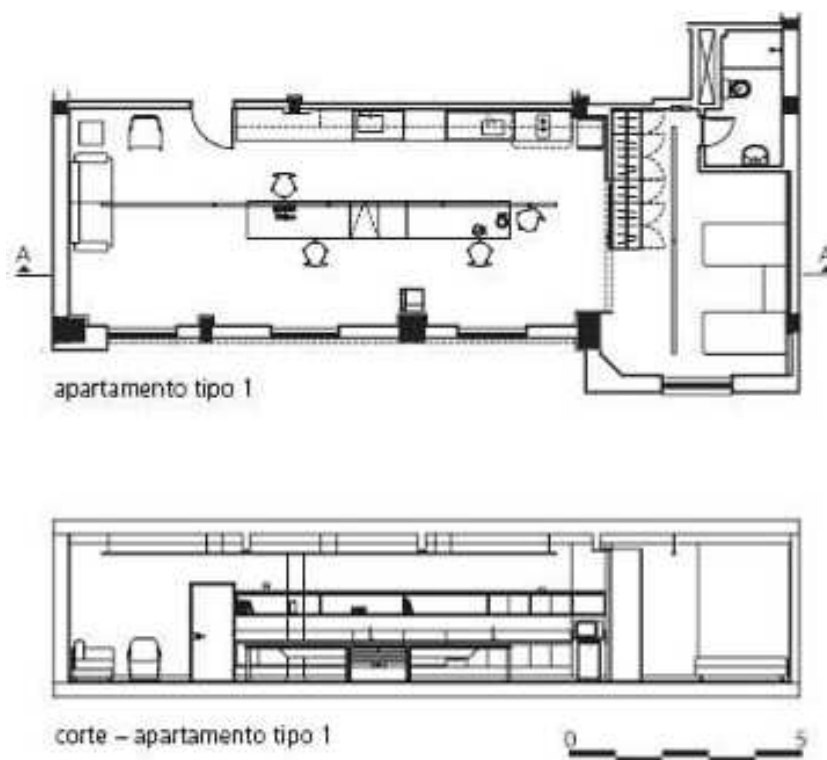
PLANTA E CORTE DO LOFT TIPO 1
